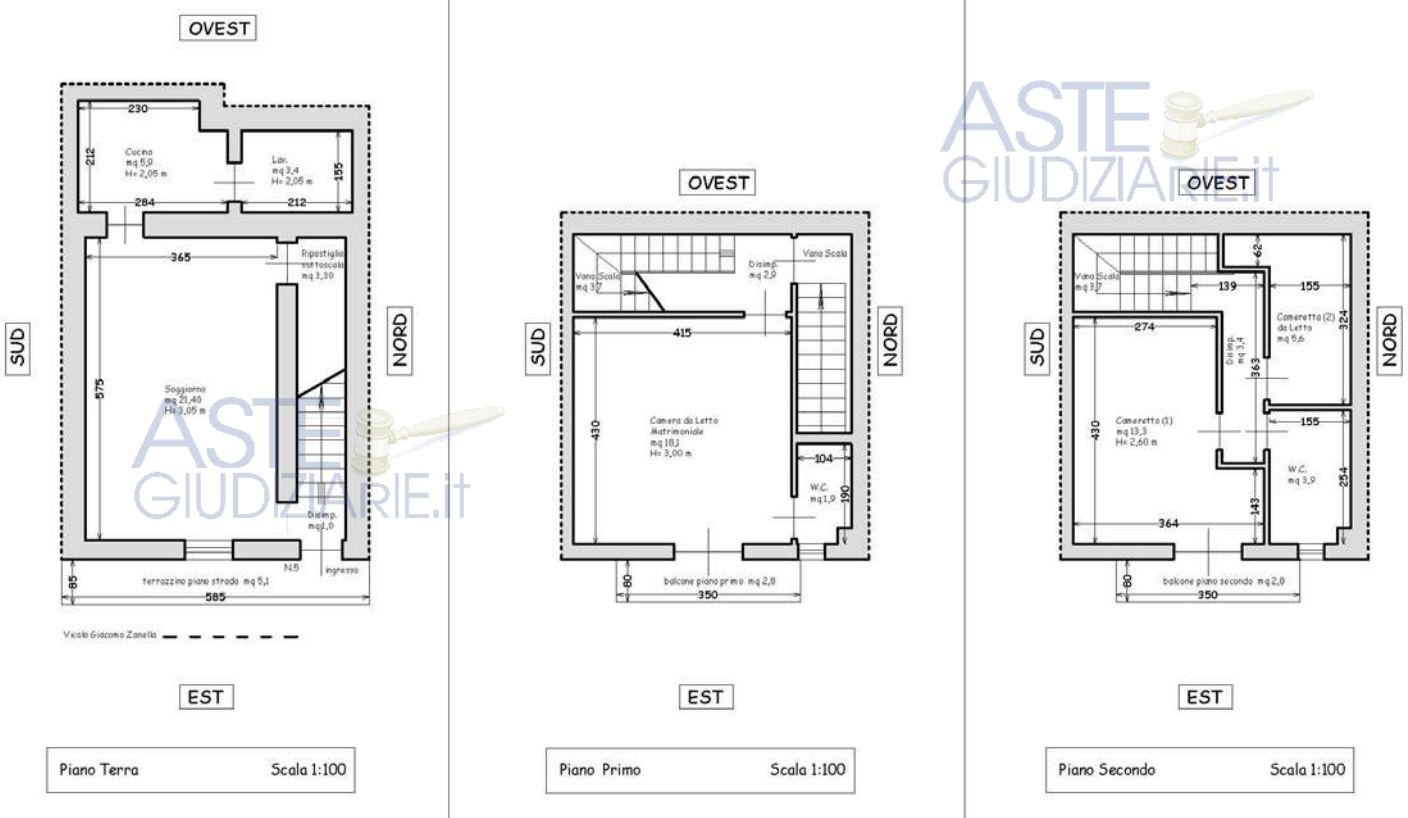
Pianta di rilievo dell'immobile: piano terra, primo e secondo
